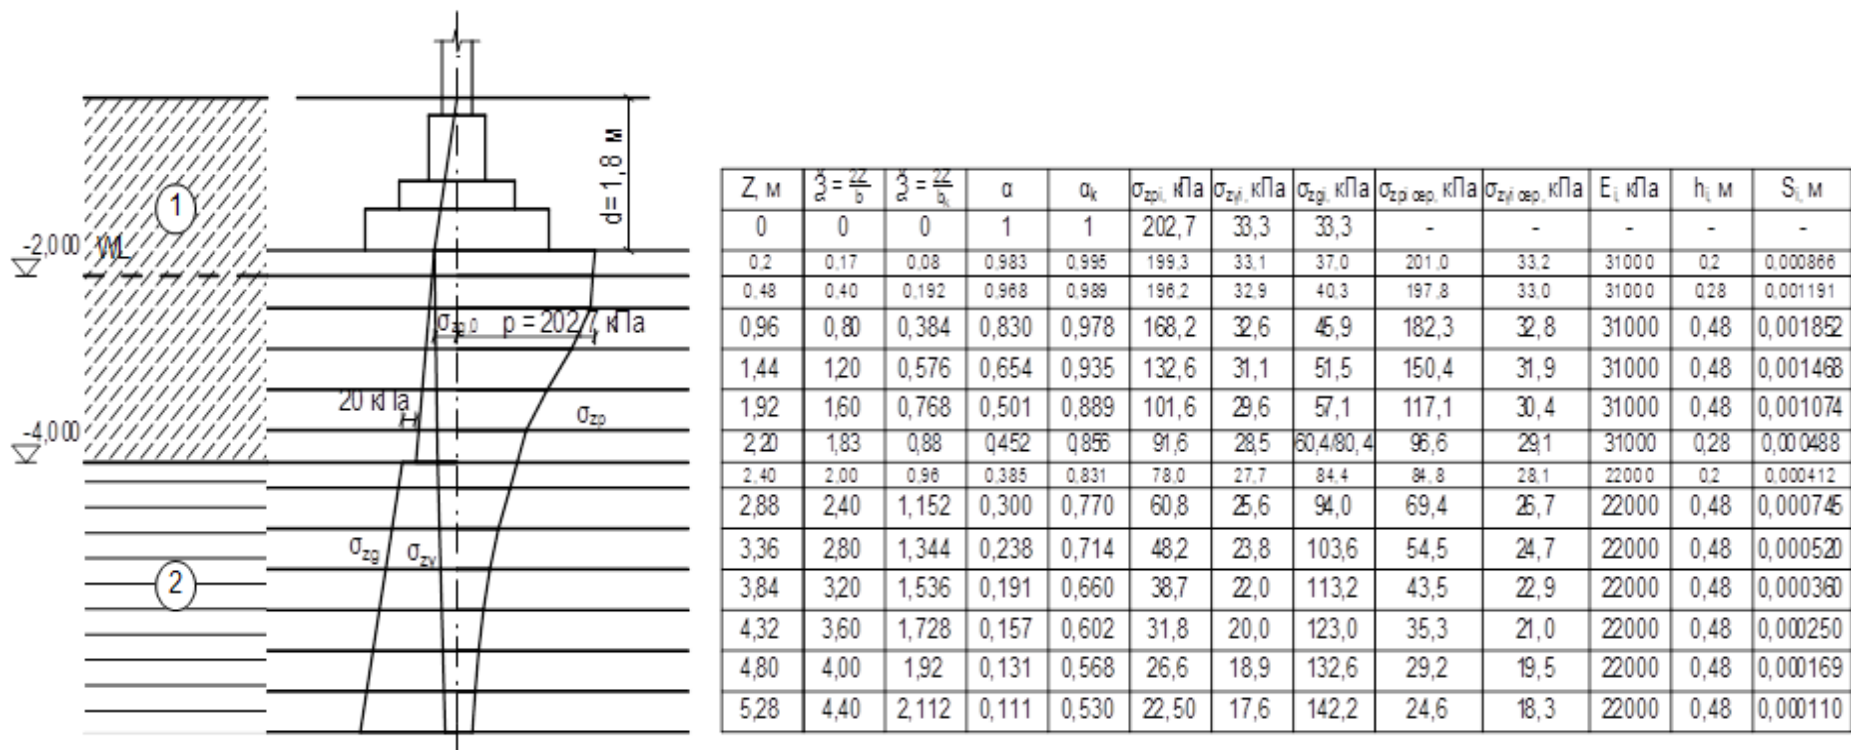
Розрахунок осідання фундаменту методом пошарового підсумовування
